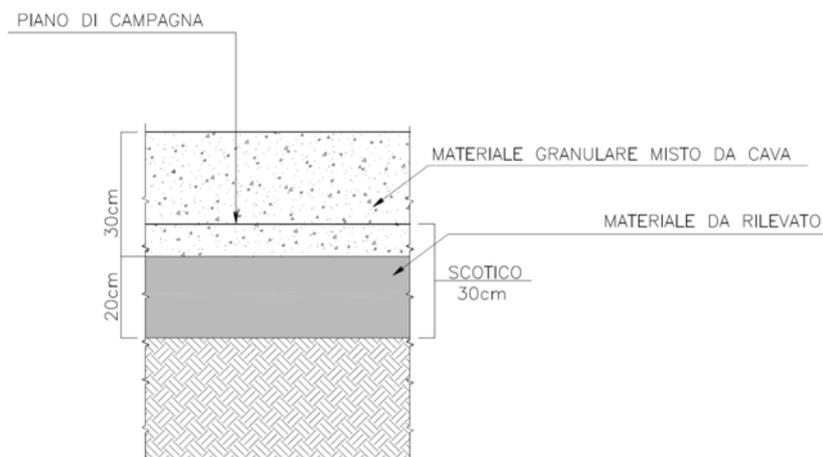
Pacchetto di pavimentazione del cantiere logistico
